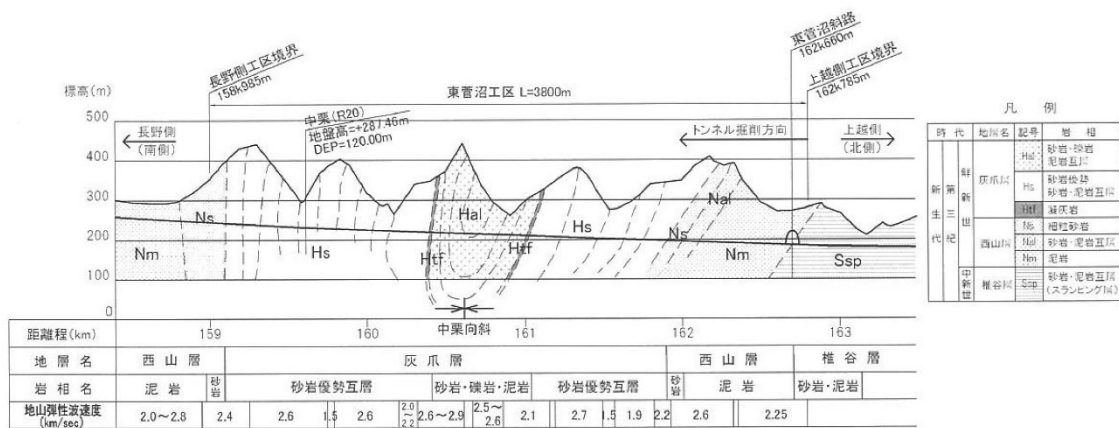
飯山トンネル東菅沼工区の地質縦断面図 49)
